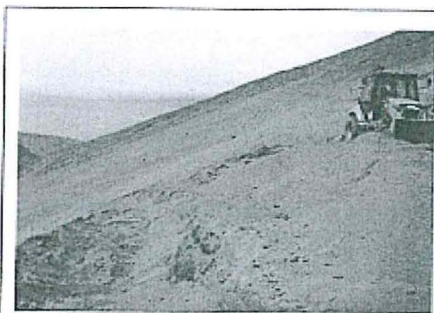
Vista Mirando hacia el Noroeste (perfilado actual).
